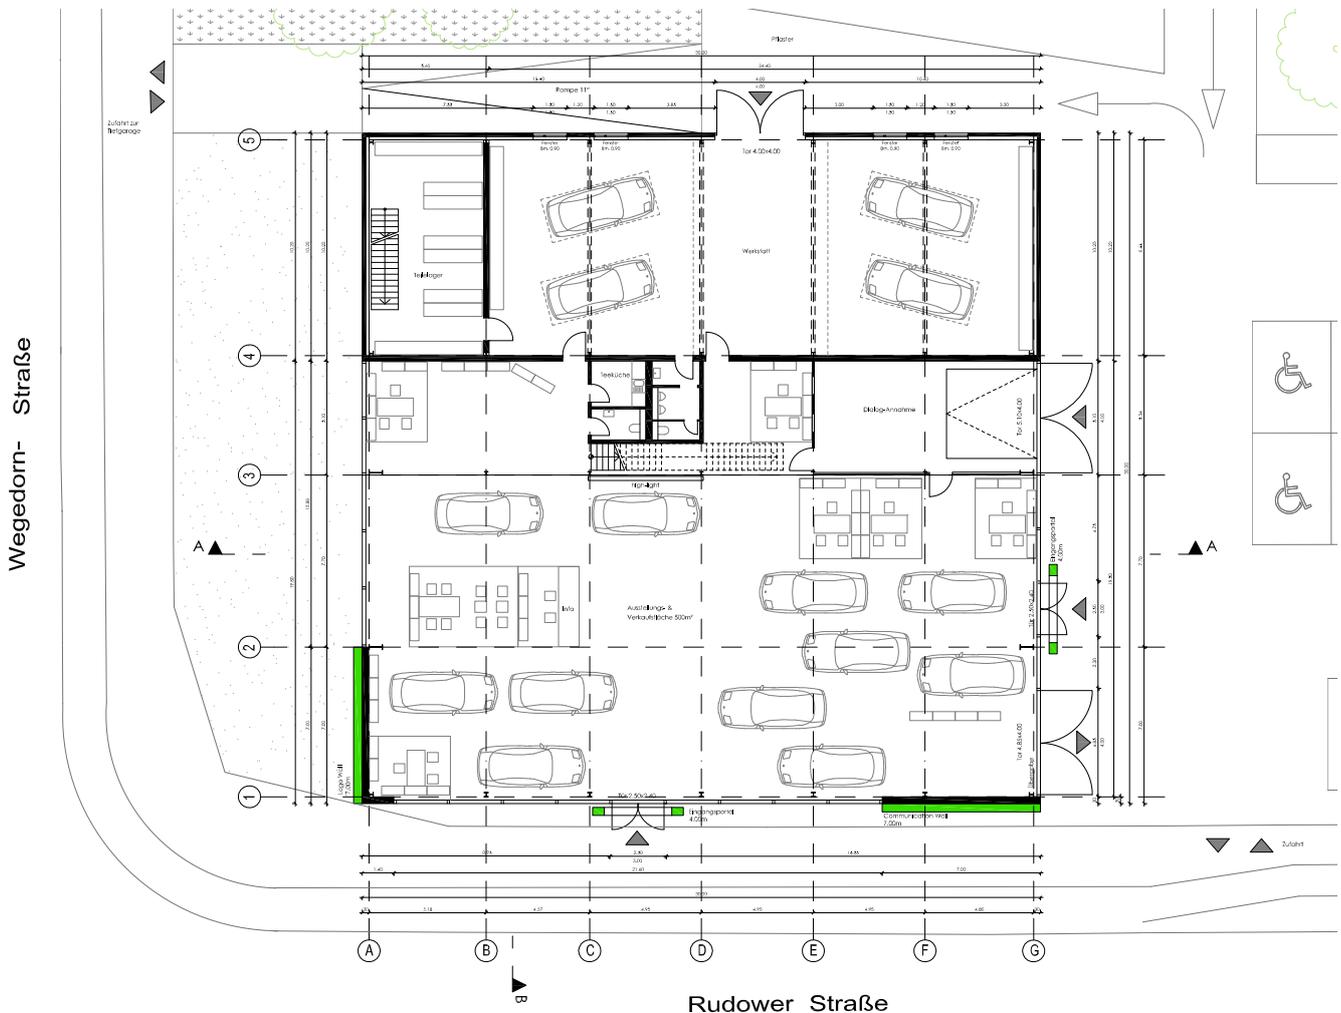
Entwurfsplanung Autohaus - Grundriss EG (Ausschnitt o.M.), 19.09.2016
